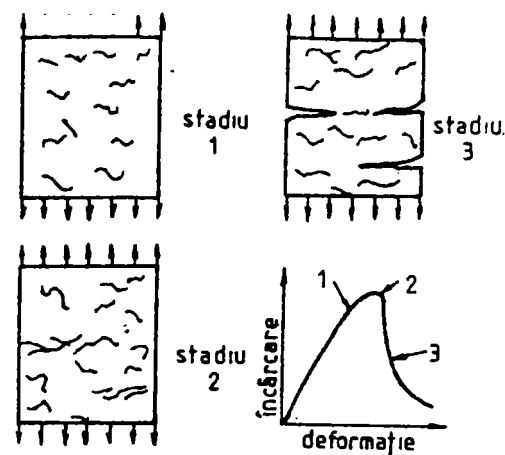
Fisurarea elementelor întinse
